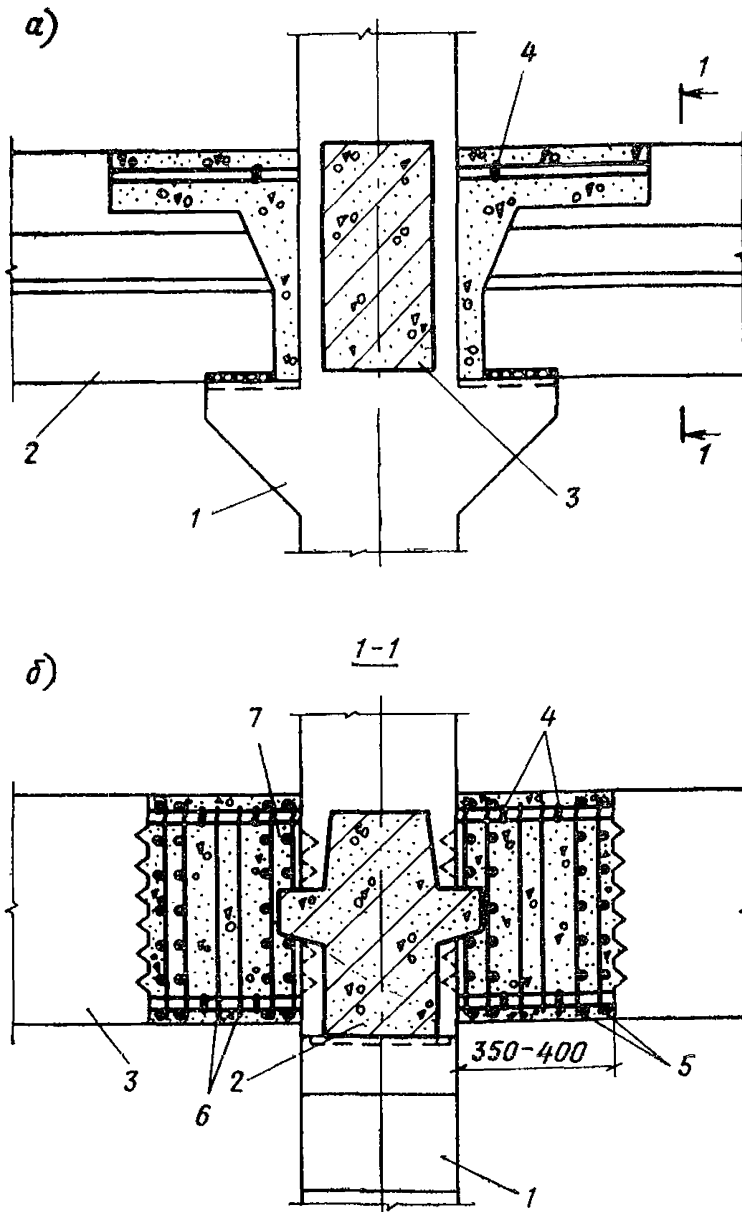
Сопряжение сборных поперечных и продольных ригелей с колонной (при бесконсольном опирании продольных ригелей)
